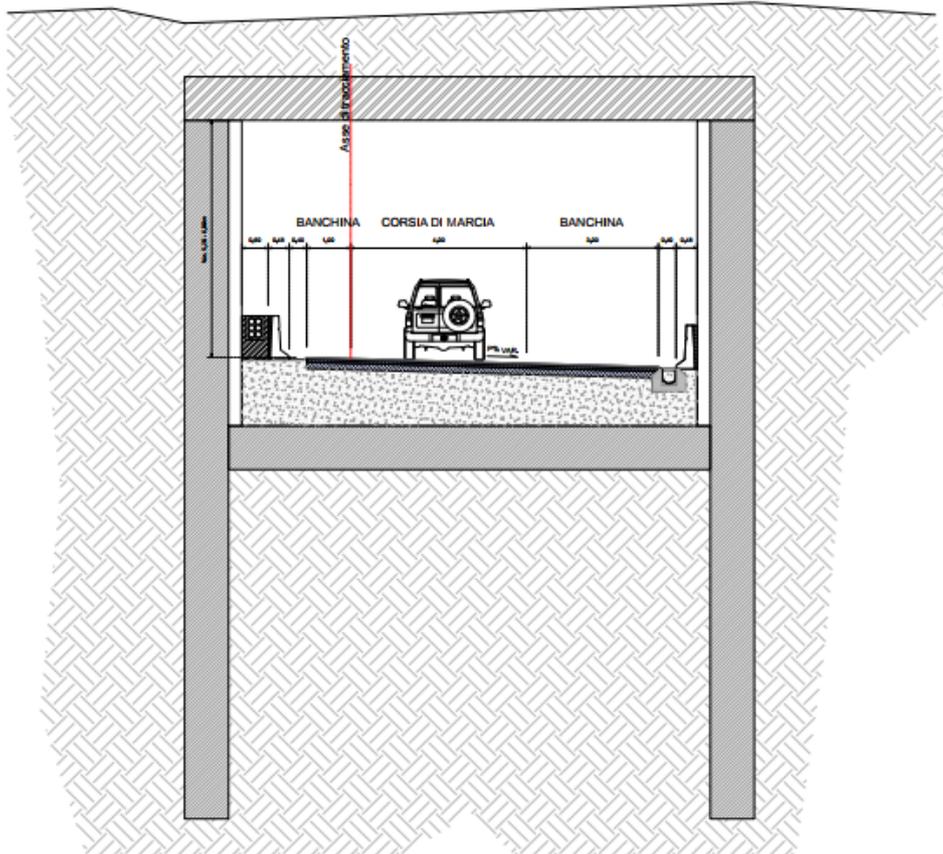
Sezione Tipo in Galleria per il ramo 1
